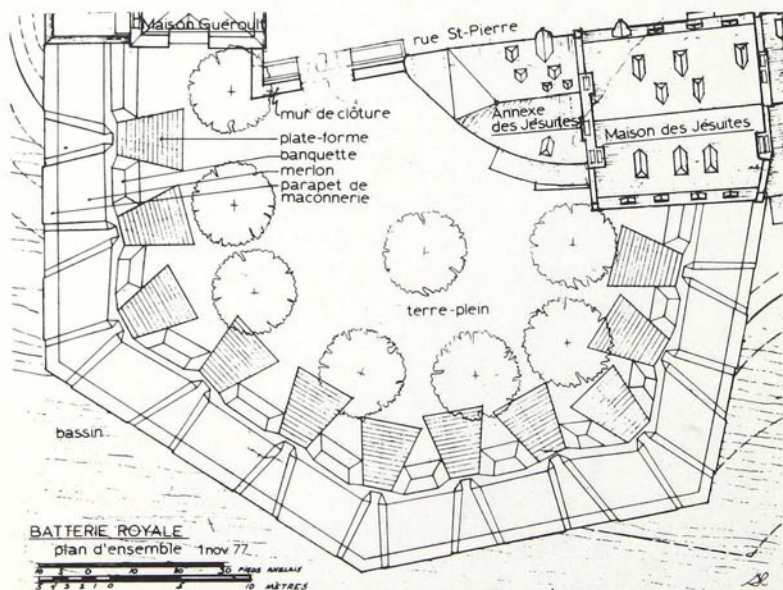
Plan d'ensemble de la Batterie Royale restaurée (dessin de Germain Courchesne)
